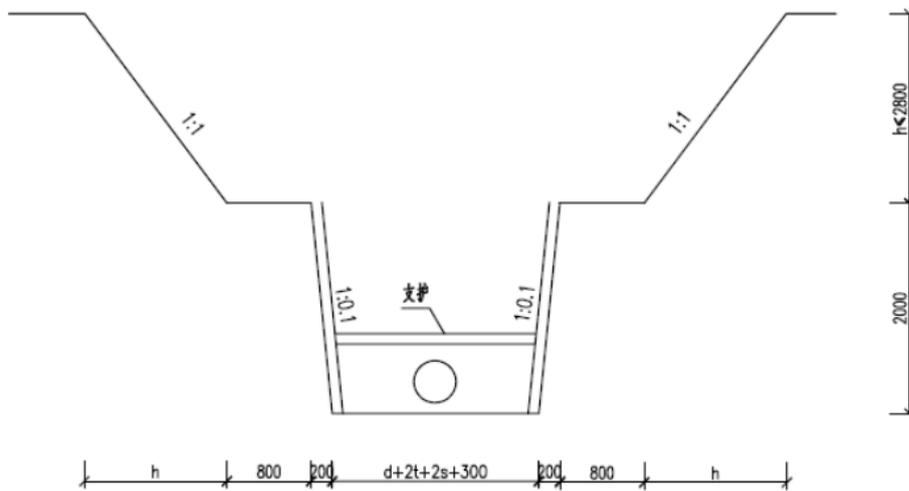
沟槽钢板桩基坑围护开挖典型横截面图
